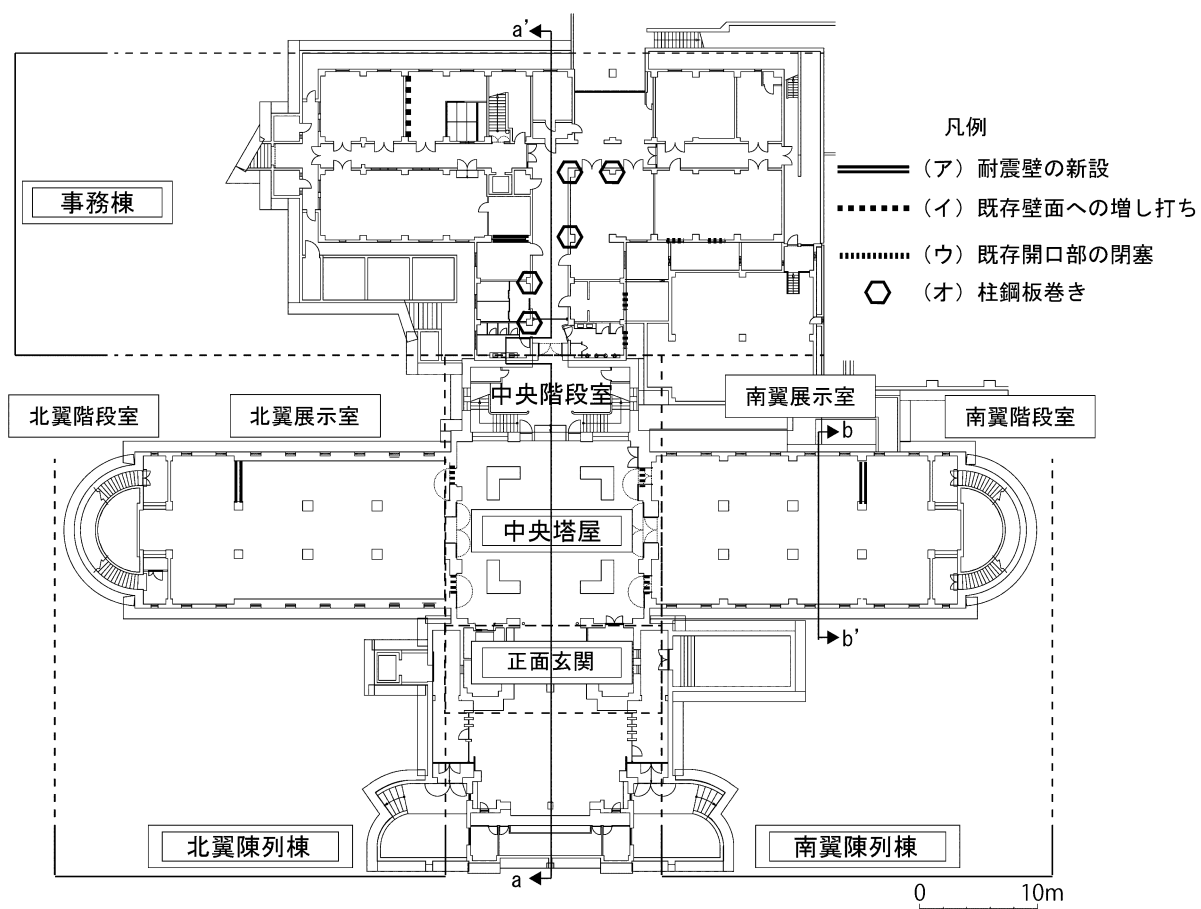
建物内の部分名称と補強位置 地下1階平面図（改修前地下1階平面図に加筆）
